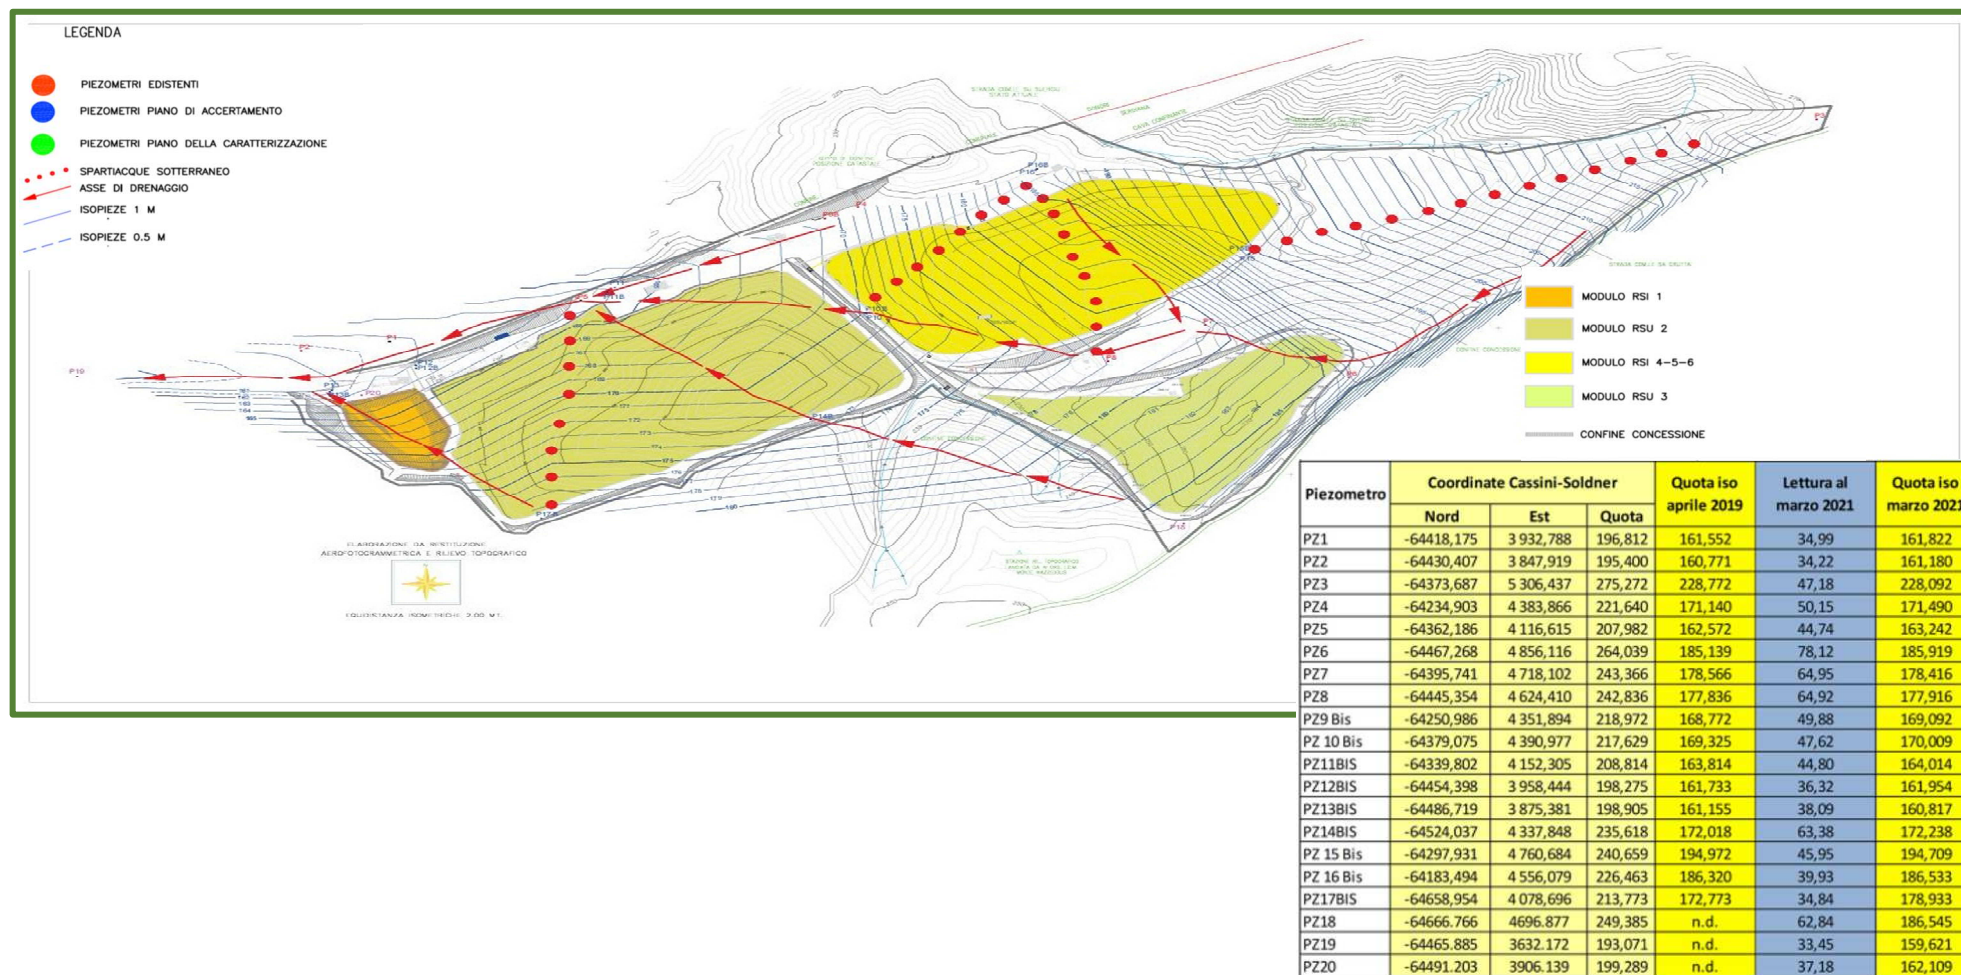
/I: Planimetria con ubicazione dei piezometri di controllo
